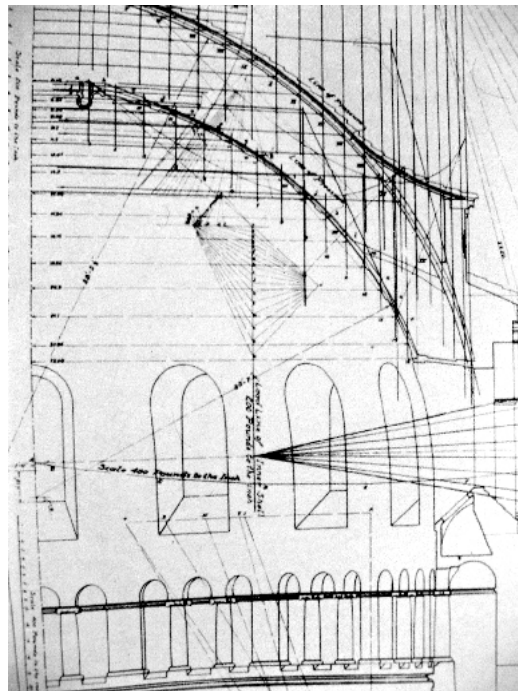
Dibujos constructivos de Guastavino y Co. para la Capilla de Saint Paul en la Universidad de Columbia (1905-1906).
